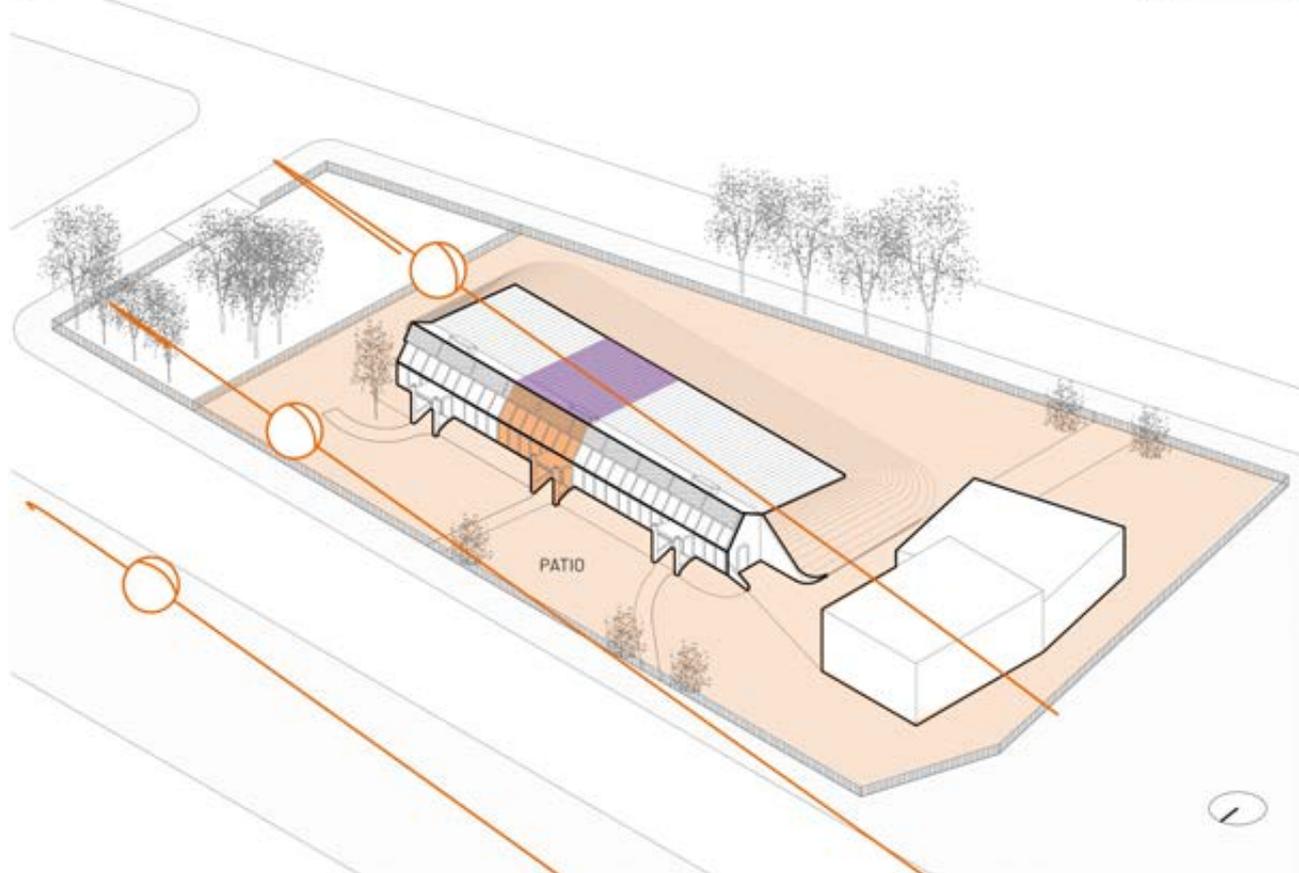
Planta. Adaptado de planos cortesía de Grupo Tagma.
